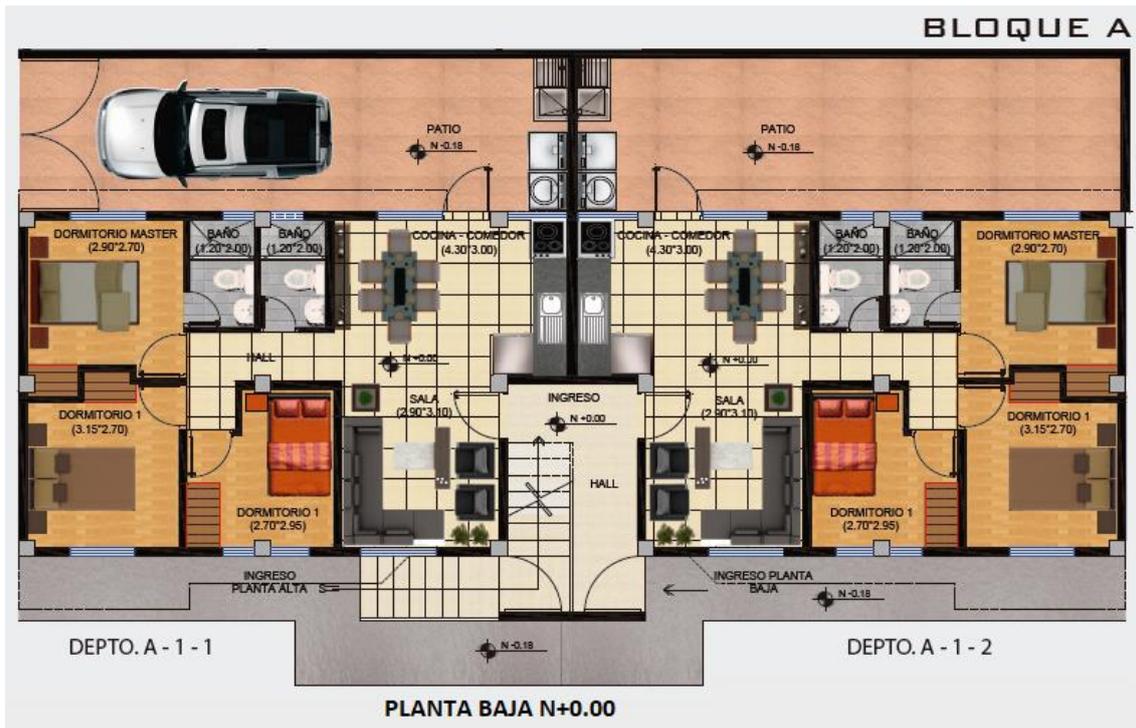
Planta Baja N+0.00 Bloque “A” de Departamentos
